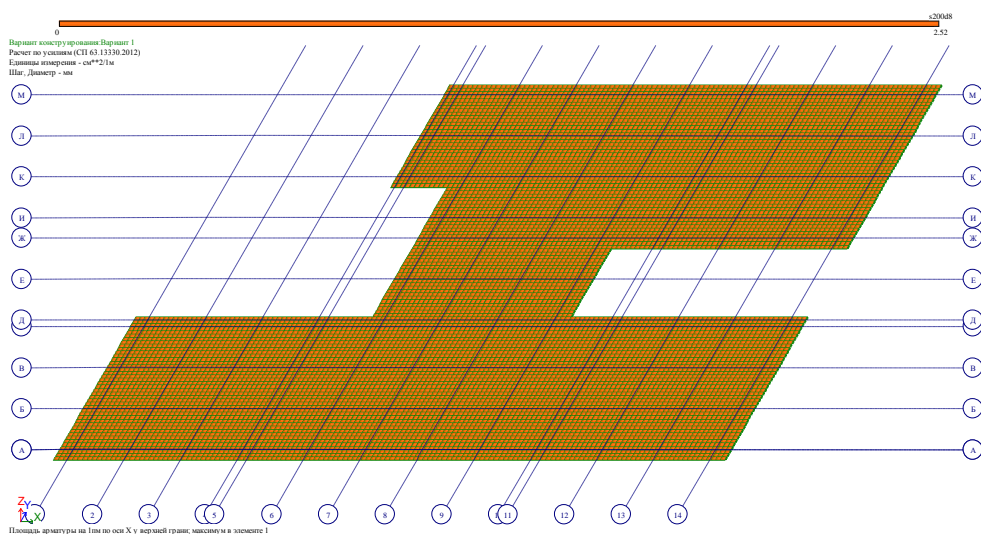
Площадь арматуры по оси X у верхней грани
